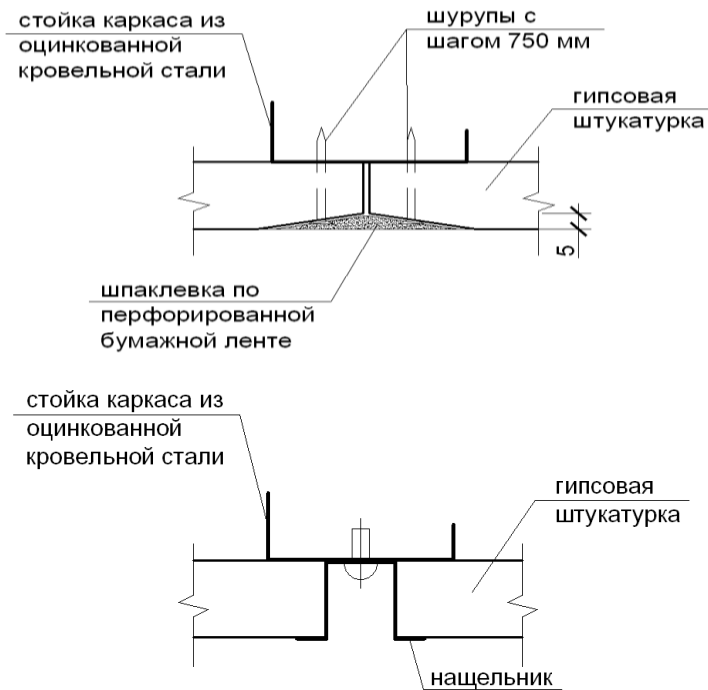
Крепление обшивок перегородки к стойкам каркаса и разделка стыков
